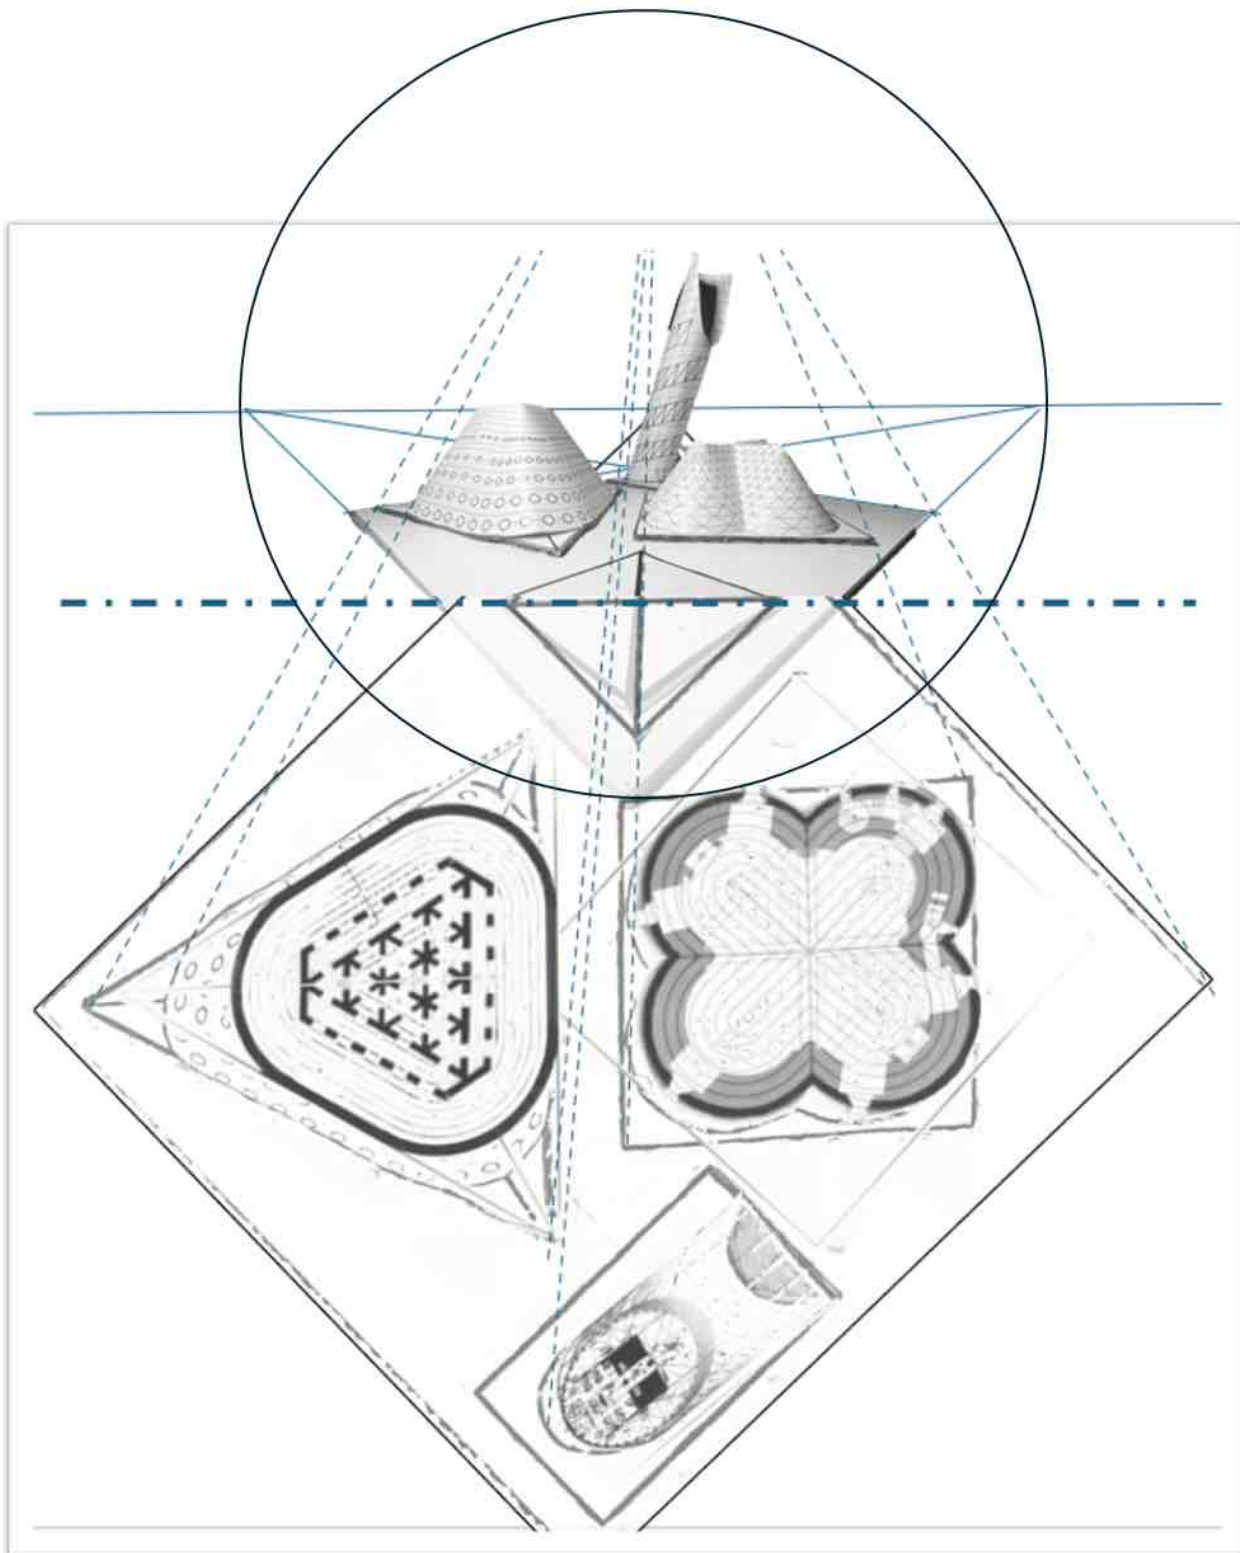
Altro esempio di una omologia che lega la pianta prospettica di una foto frontale dell'intero modello alla sua sezione planimetrica in vera forma.
